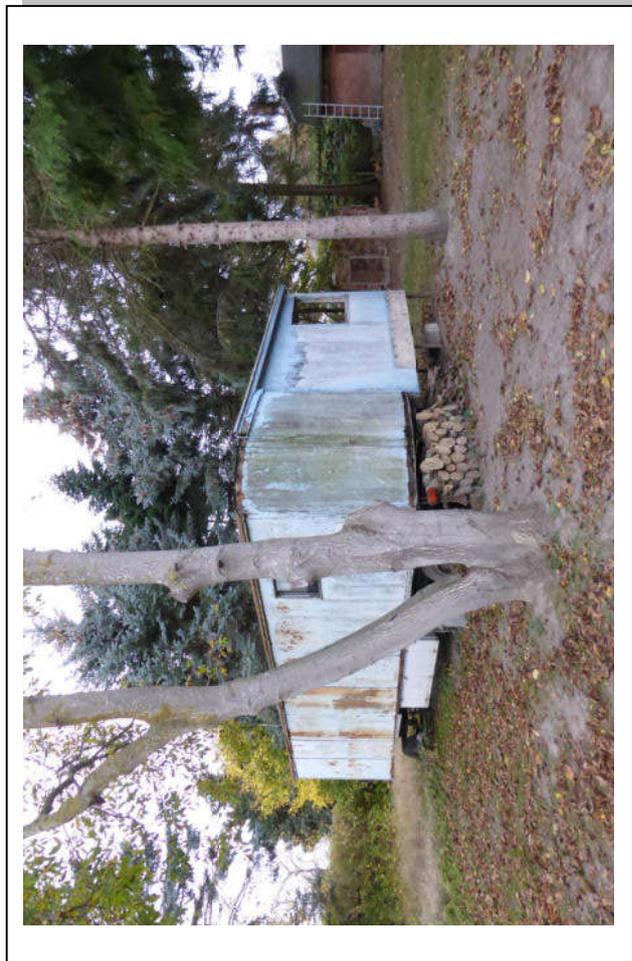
o links und rechts: Ansichten vom Gebäude 3: Wohnanhänger mit Verandavorbau (ruinös)
